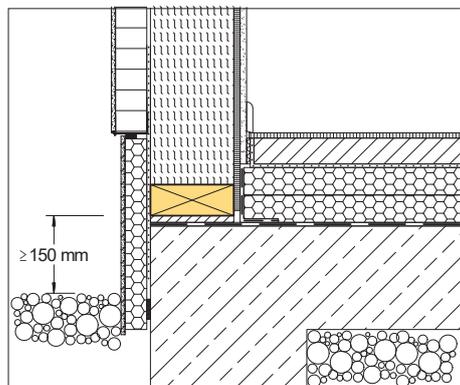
Der Sockel mit Kiesstreifen stellt eine seit langem bewährte Lösung im Holzrahmenbau dar.
